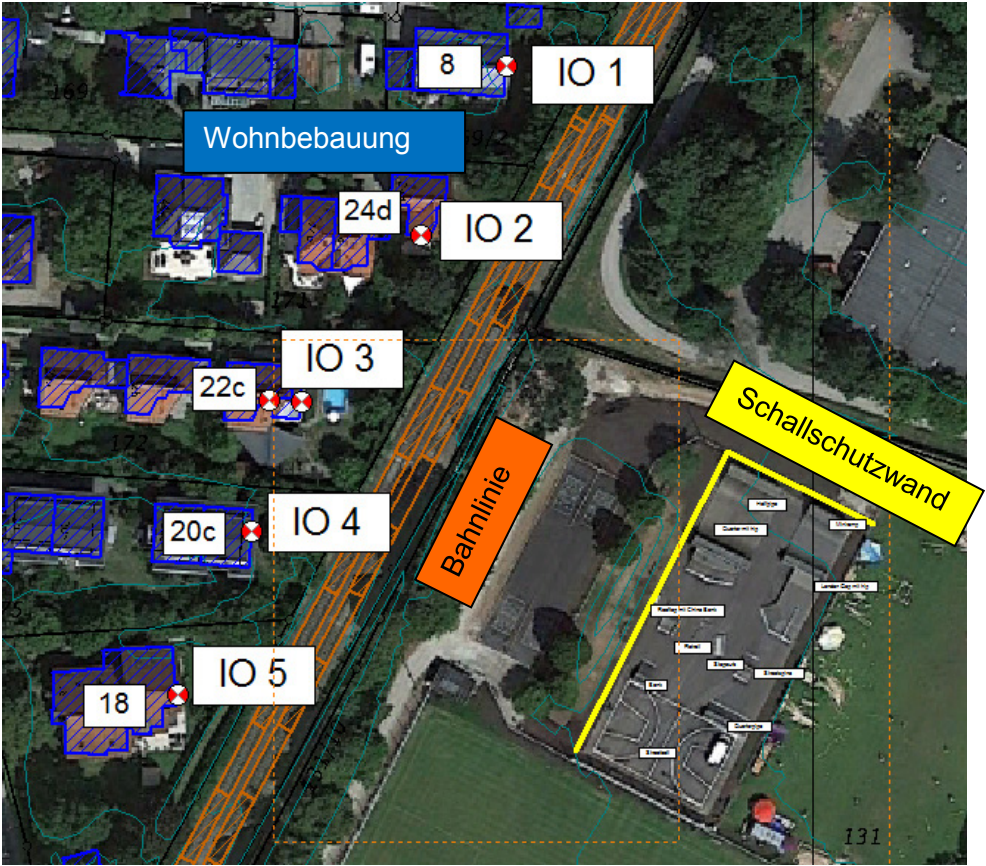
Übersichtslageplan Wohnbebauung an der Münchener Straße, Bahnlinie, Schallschutzwand Skatepark (ohne Maßstab).
